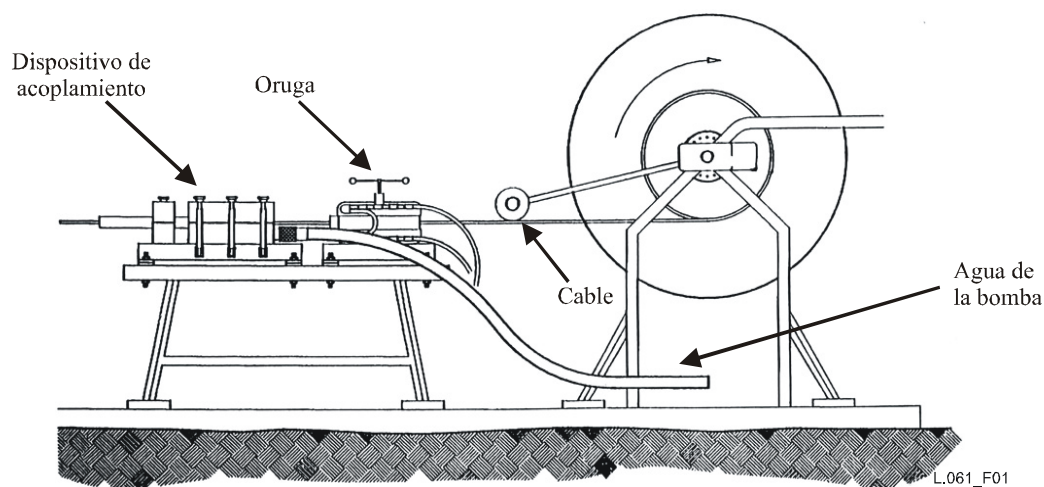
/L.61 – Ensamblaje general de la máquina flotante
